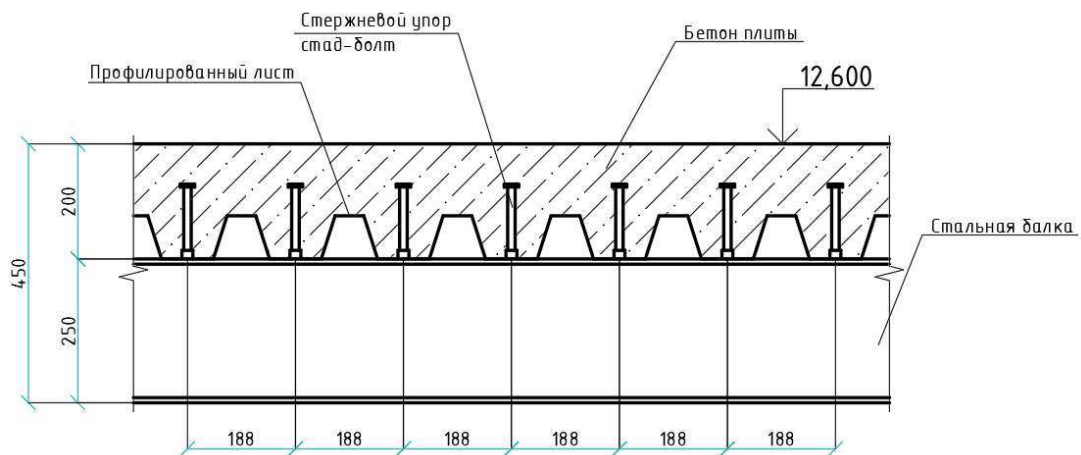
Конструкция сталежелезобетонного перекрытия (вариант 1)
